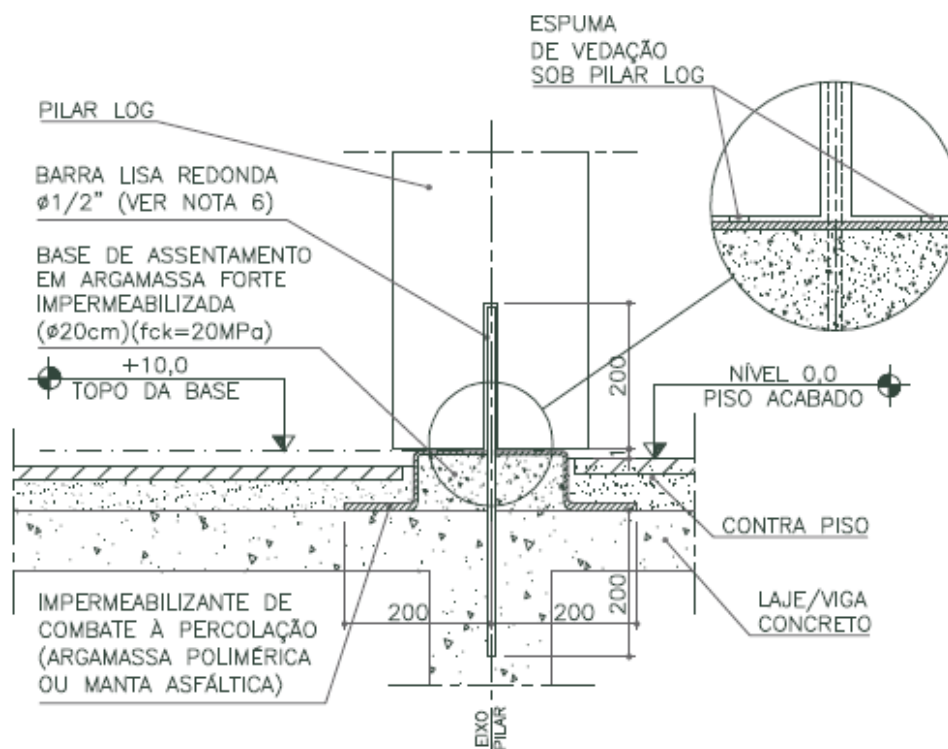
Vista frontal do detalhe de afastamento do pilar em relação ao piso. Projeto cedido pela EMPRESA B.
